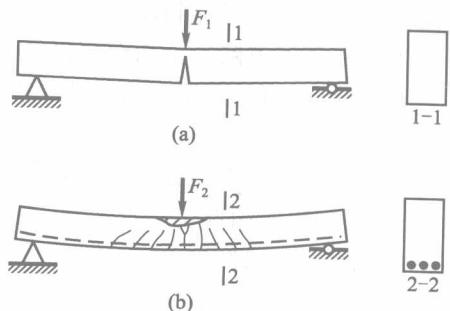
钢筋混凝土梁与素混凝土梁的比较
